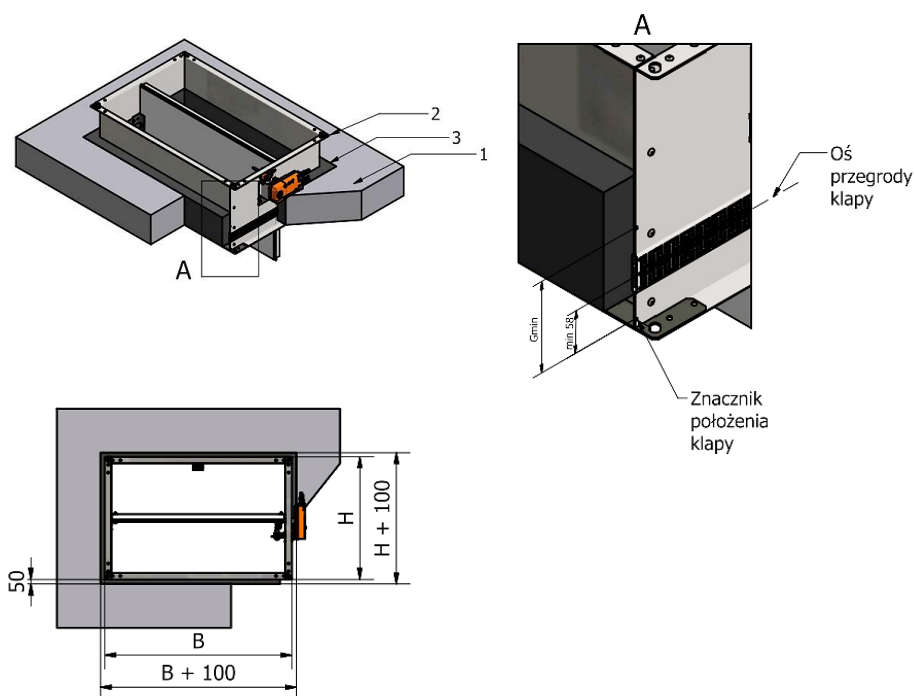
Przykład montażu kłapy V330M-EX w ścianach betonowych lub murowanych
